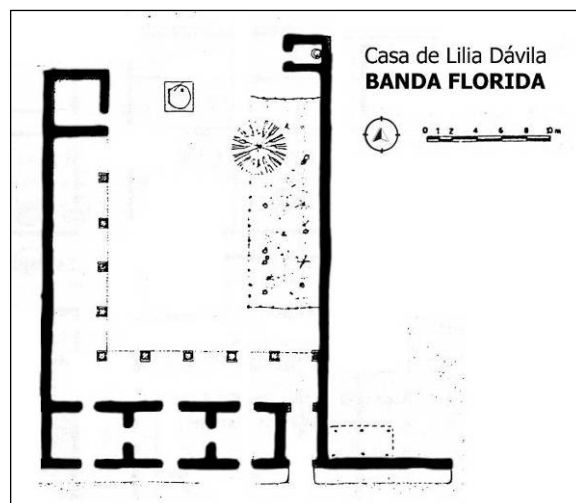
Plano de la casa de la Sra. Lilia Dávila en Banda Florida (modificado de Canepuccia et al. 1976)
